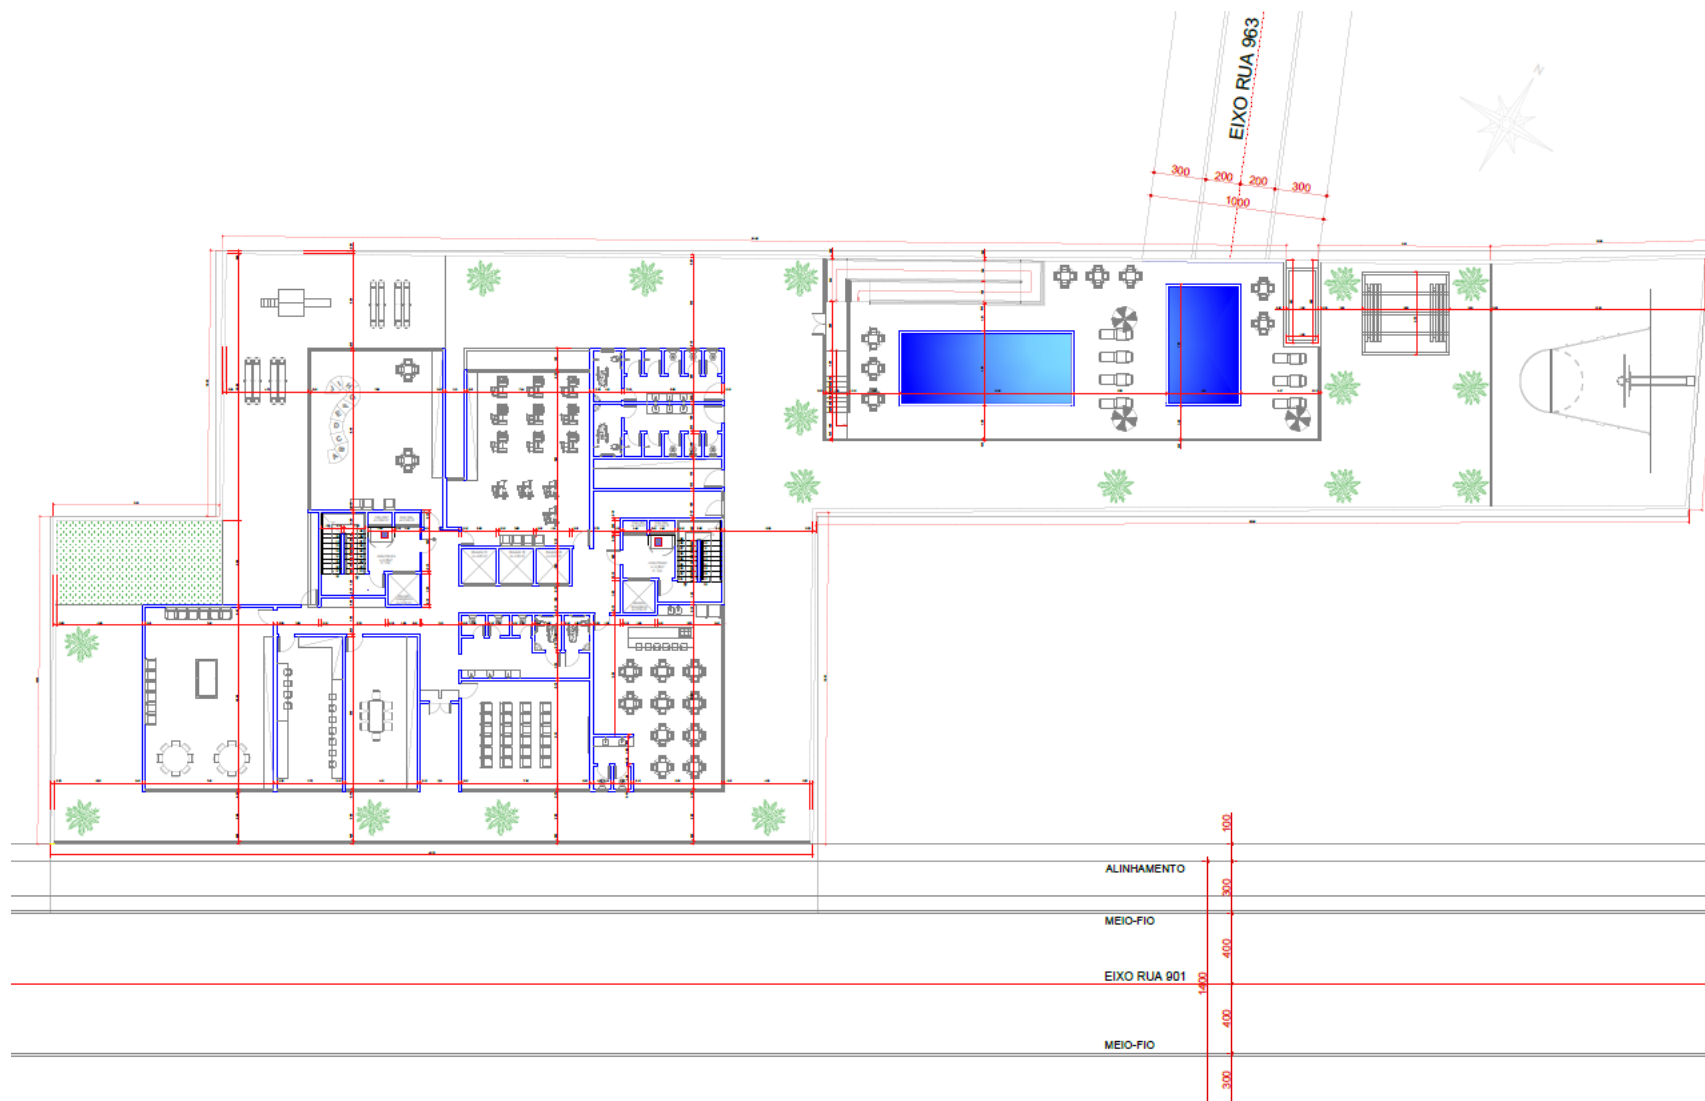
Planta Baixa - 6º Pavimento Lazer - Área: 2.063,10m².
